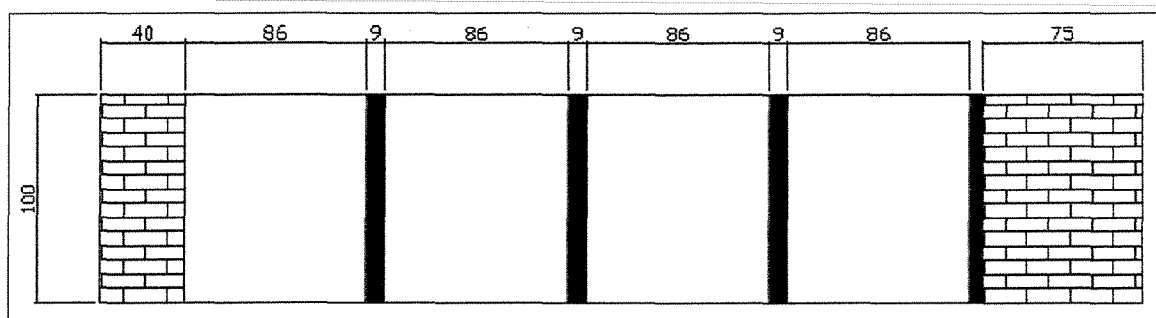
Planta baixa da câmara de secagem (cotas em cm)
